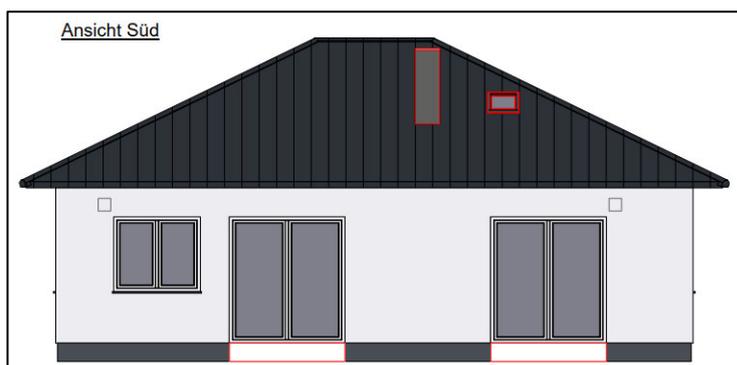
Haus B80 Fassade Wohn- und Schlafzimmer
